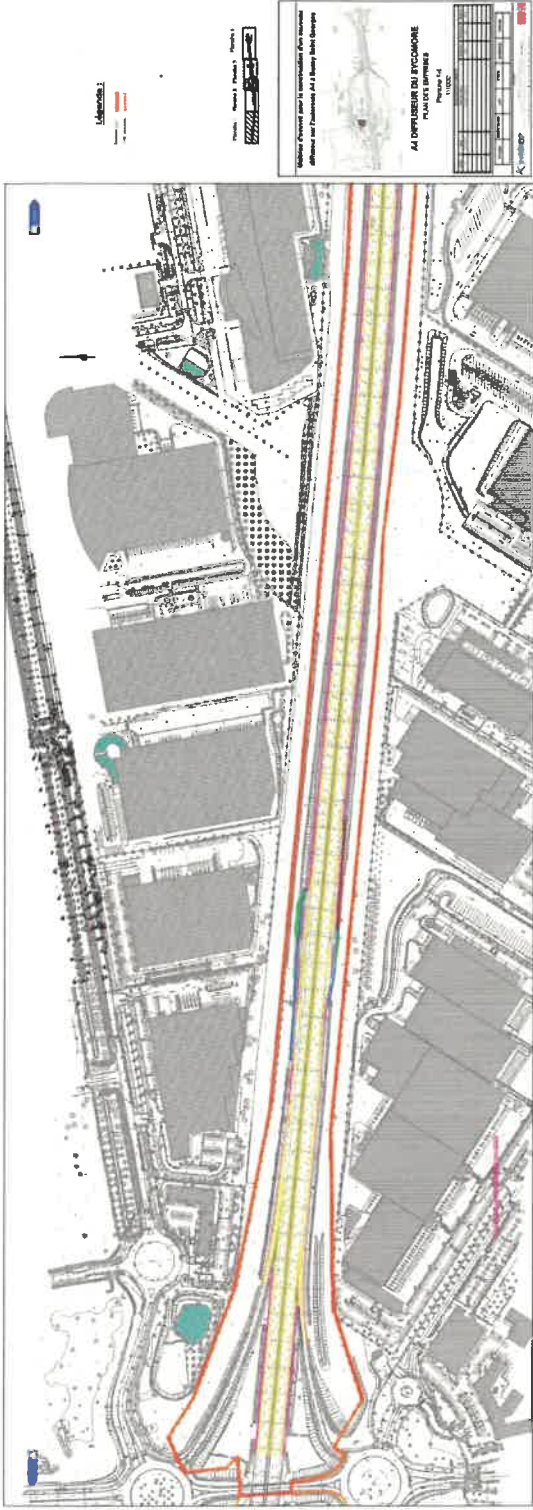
Plan des emprises travaux au droit du diffuseur de Ferritères-en-Brie, commune de Bussy-Saint-Georges
